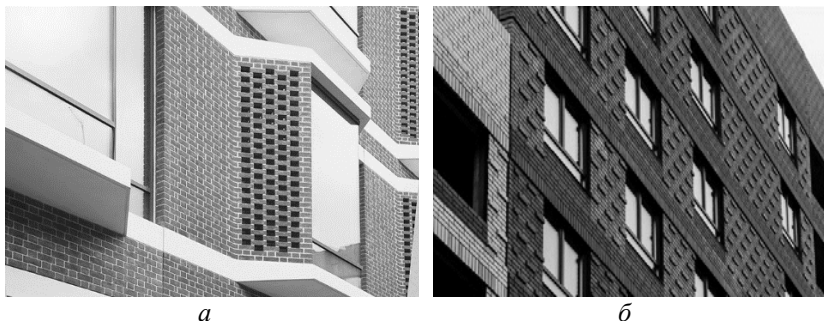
Примеры фасадов зданий из крупноразмерных элементов:
